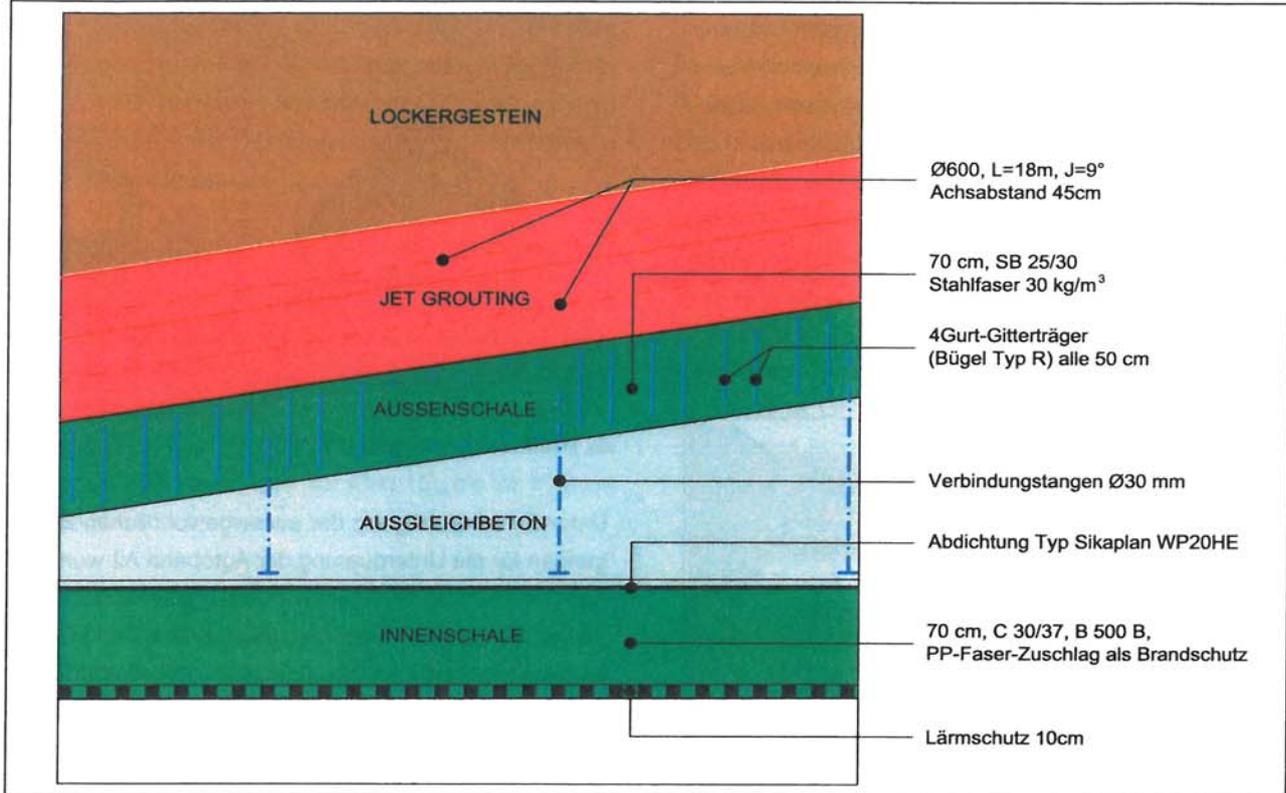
Ausbruchssicherung und Innenschale – Konstruktionsdetail
